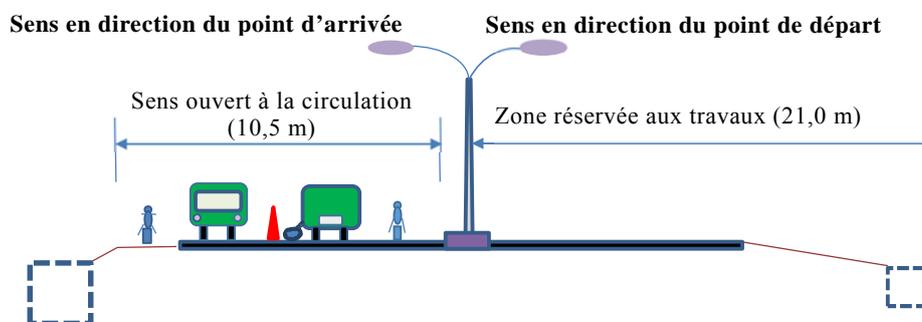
Vue en coupe des conditions de contournement de la circulation sur la route existante (sens en direction du point d'arrivée) (Assujettissement de l'espace pour permettre la circulation sur 4 voies)
